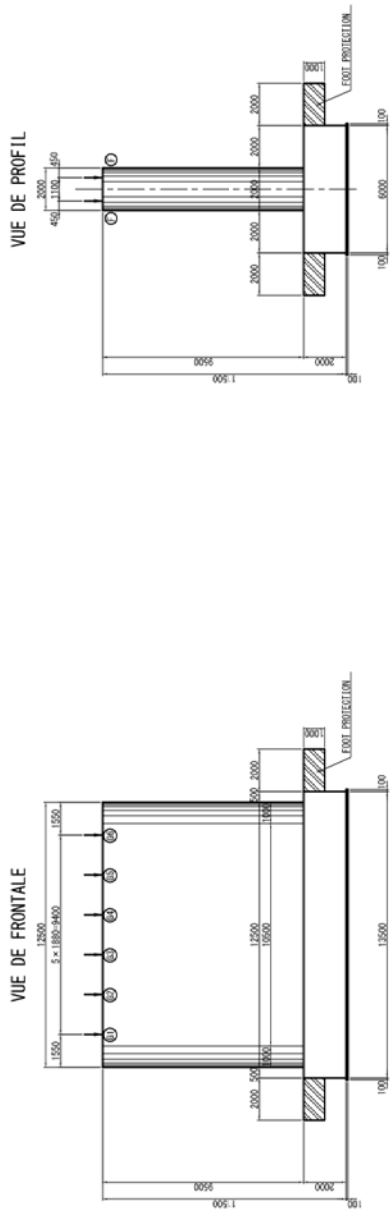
Plan de construction de l'infrastructure du pont sur le fleuve Kara (1)
